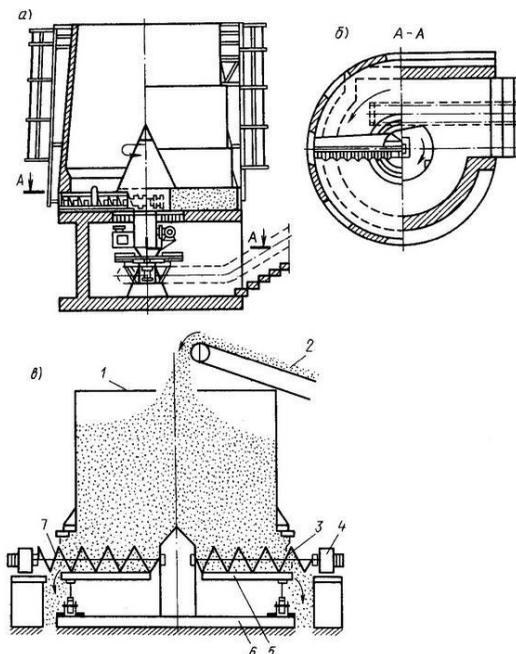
Открытый шахтозапасник, продольный (а) и поперечный (б) разрезы; механизированный башенный силос, продольный разрез (в): 1 – корпус; 2 – конвейер; 3 – шнек; 4 – привод; 5
